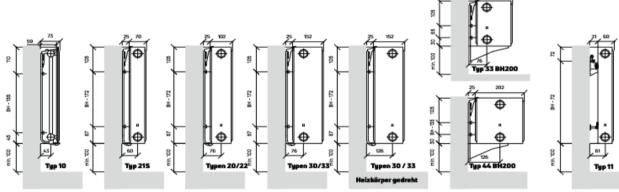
Montagemaße für Ventil Compact Typen 10, 20, 21S, 22, 30, 33 und 44
